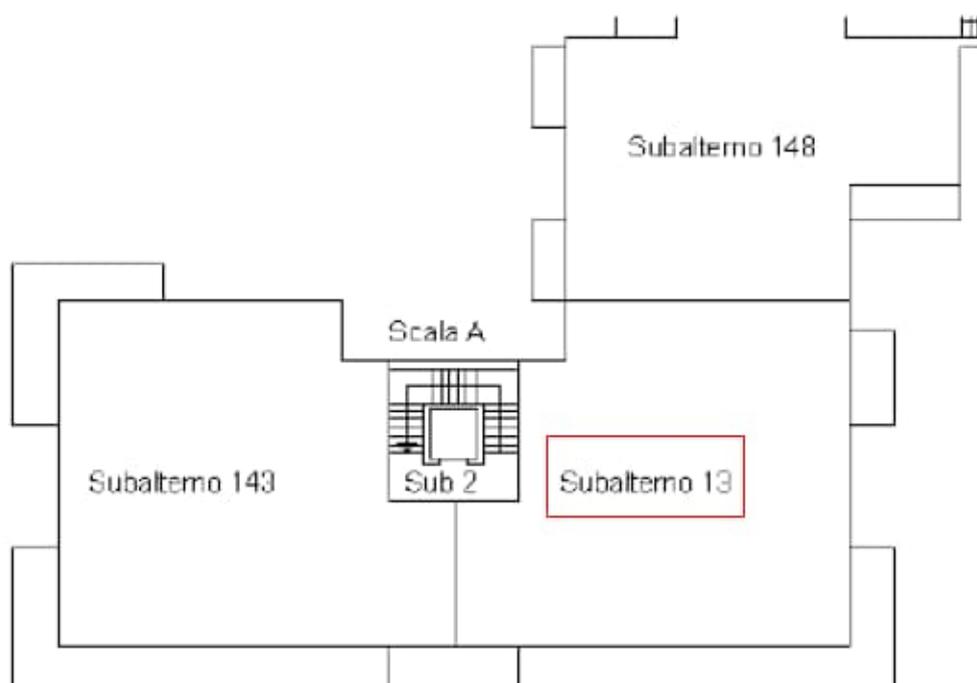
Estratto dell'Elaborato Planimetrico, dal quale dedurre i confini del subalterno 13 (appartamento ubicato al piano primo)
